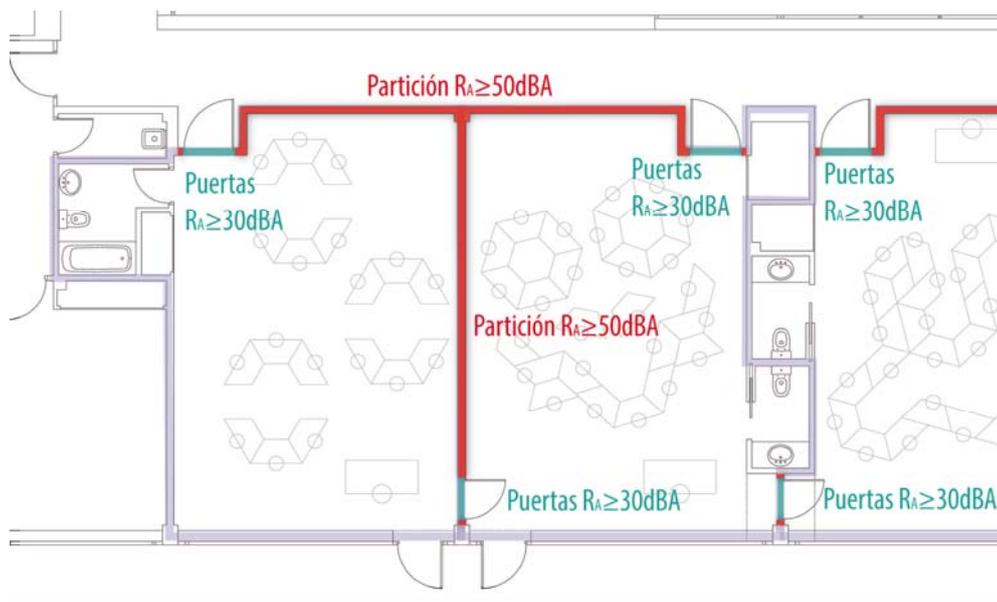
Detalle planta de aulas con indicación de exigencias aplicables a las particiones con puertas y a las puertas.
